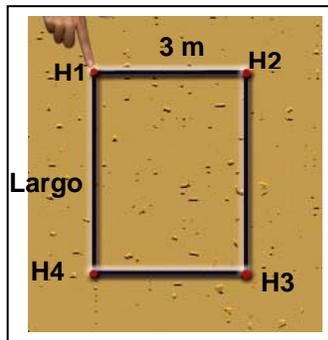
Plano del trazo de la casa que plantea Gilberto
